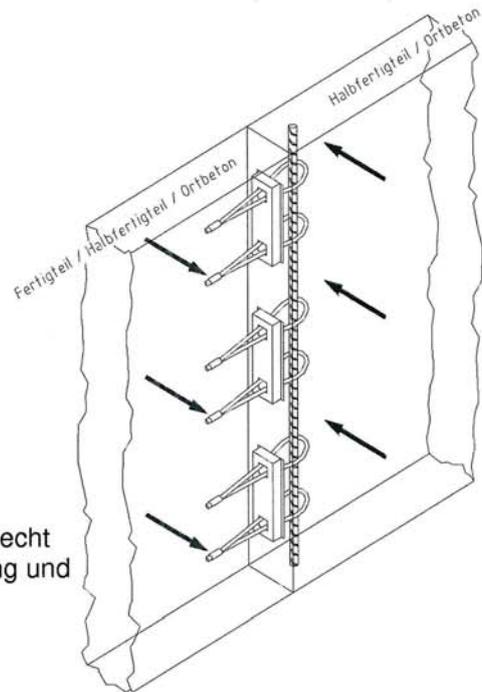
Beanspruchung senkrecht zur Fugenlängsrichtung und Wandebene
